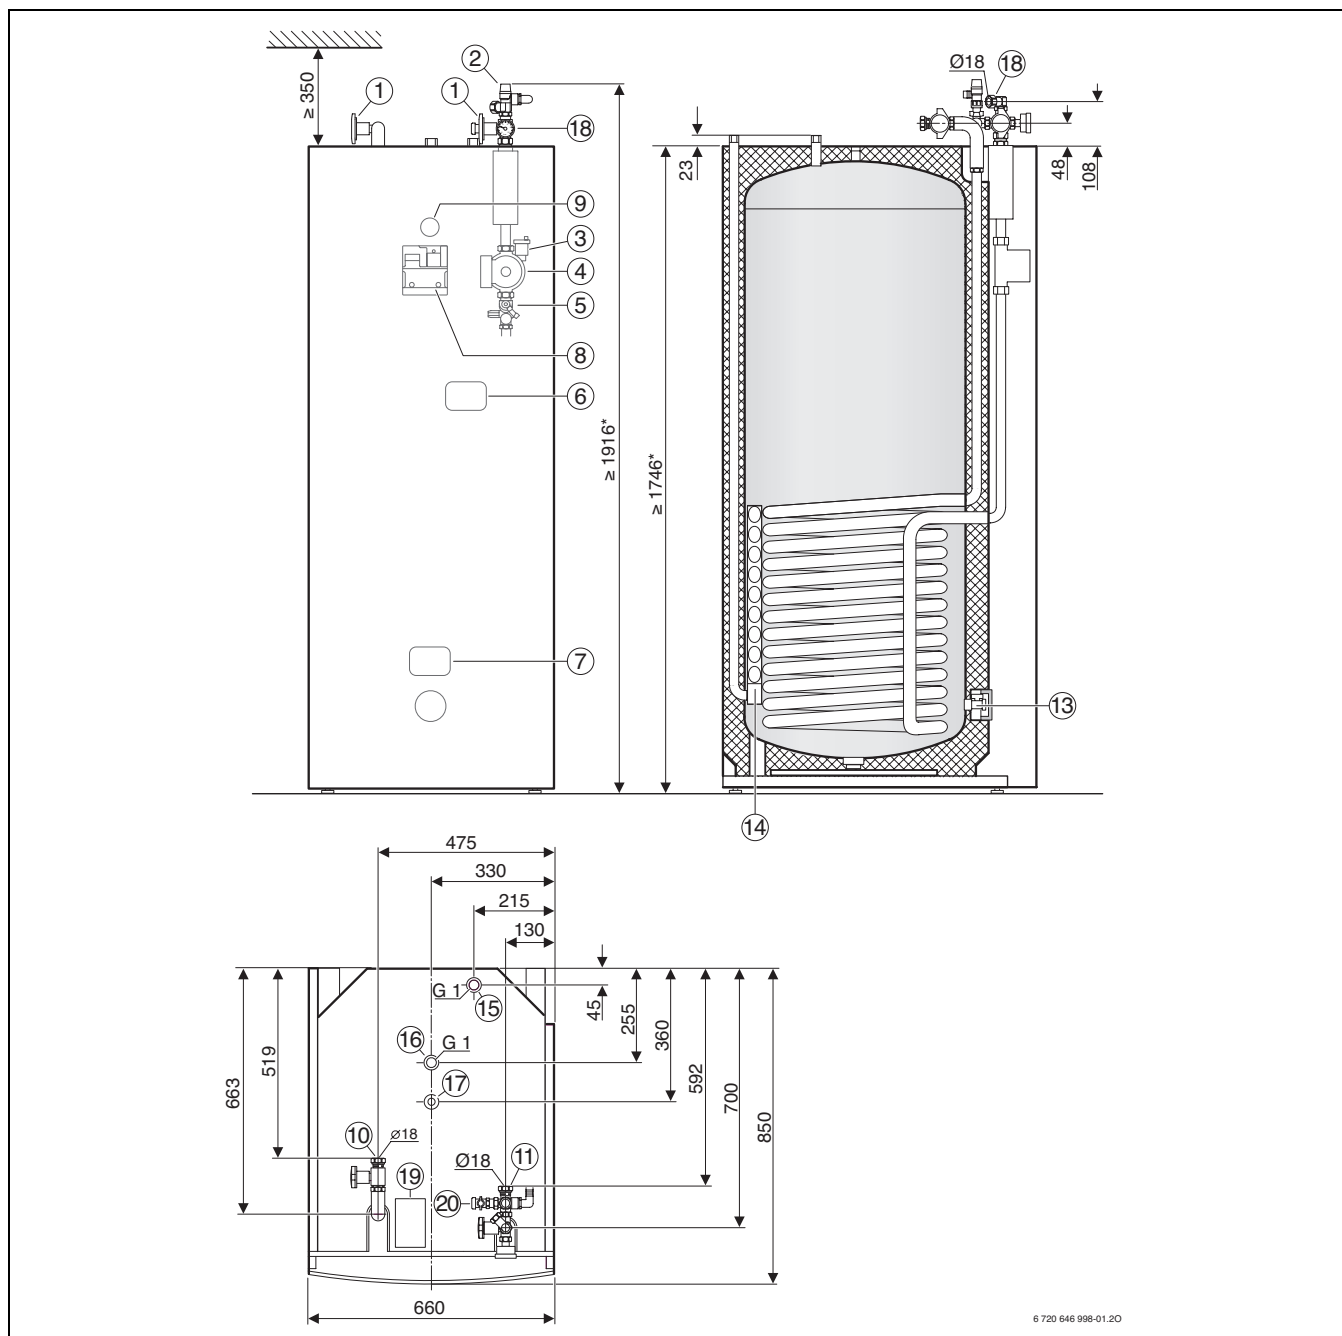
Dimensioni montaggio e attacchi PNRS400
